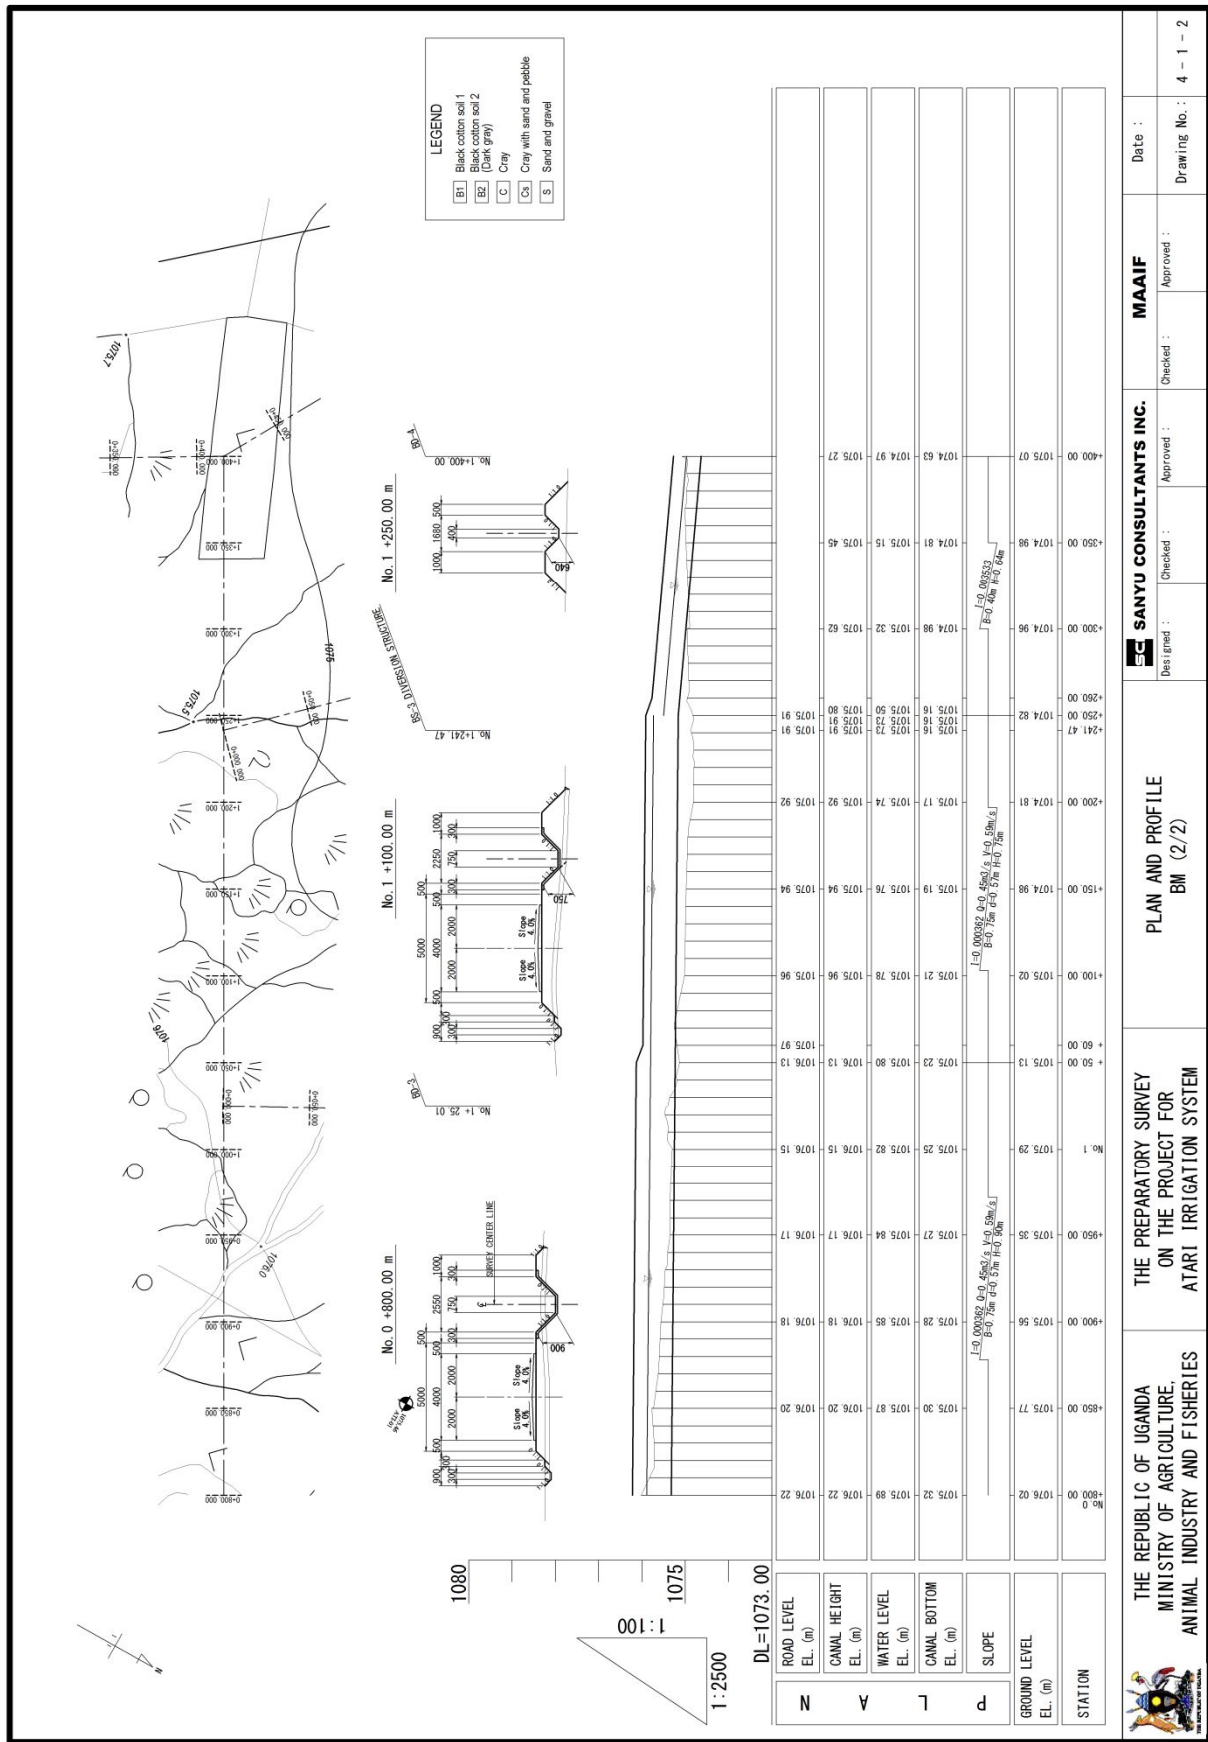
ブランブリ県幹線水路(BM) 縦断面図
